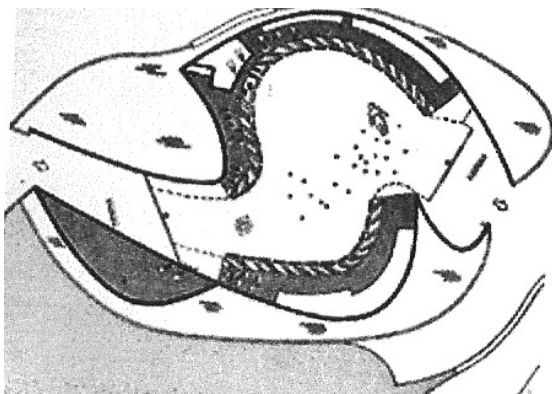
Estudo da planta do Pavilhão Philips, 1958.
